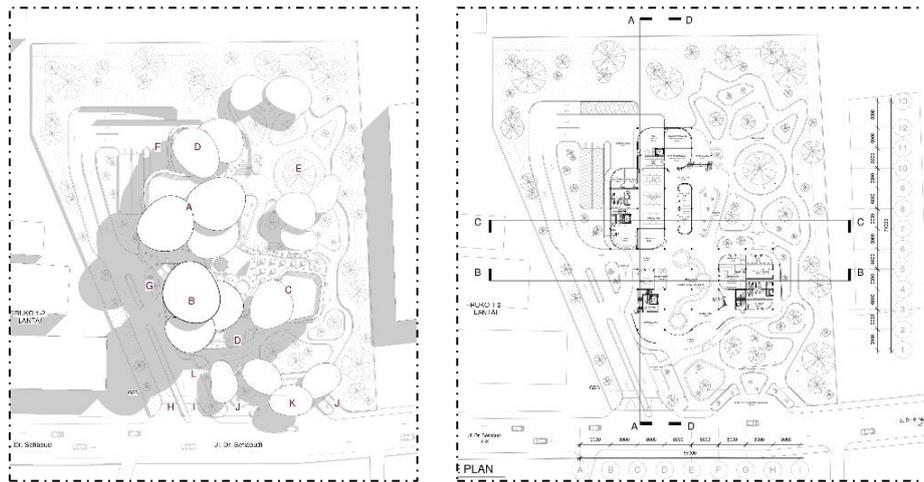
Bentuk *Layering Floor to Floor* Antar Massa dan Ruang Publik (Taman)
